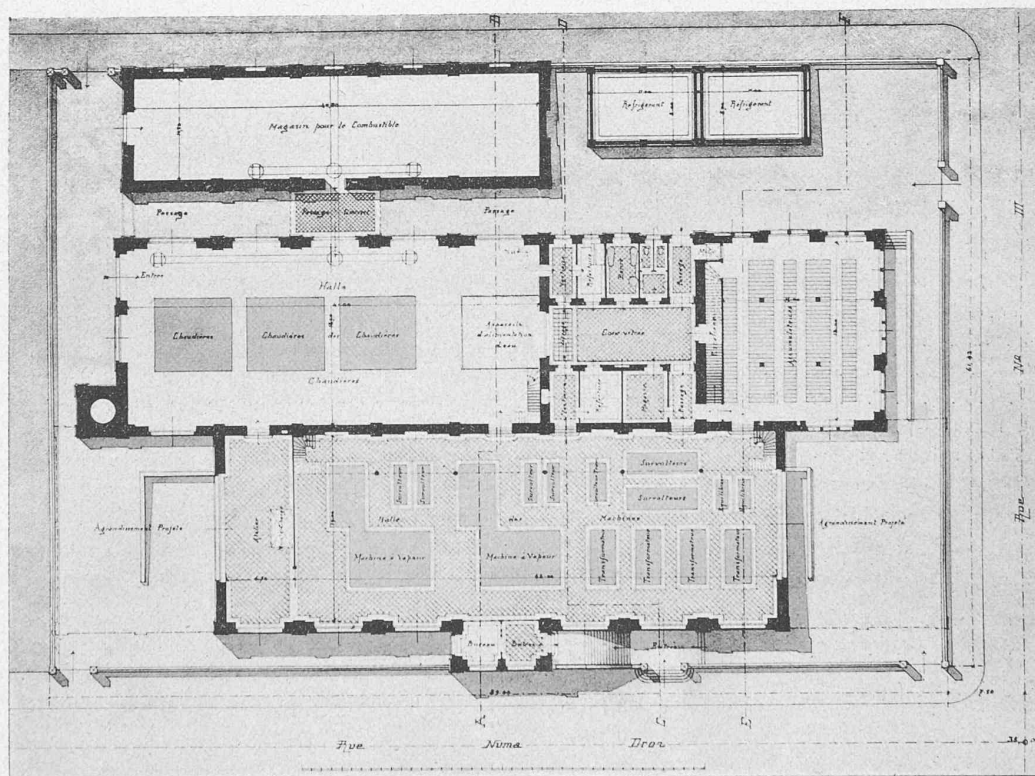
Projet « Edison ». — Plan du rez-de-chaussée. — Architecte : M. L. Reutter, à La Chaux-de-Fonds.
